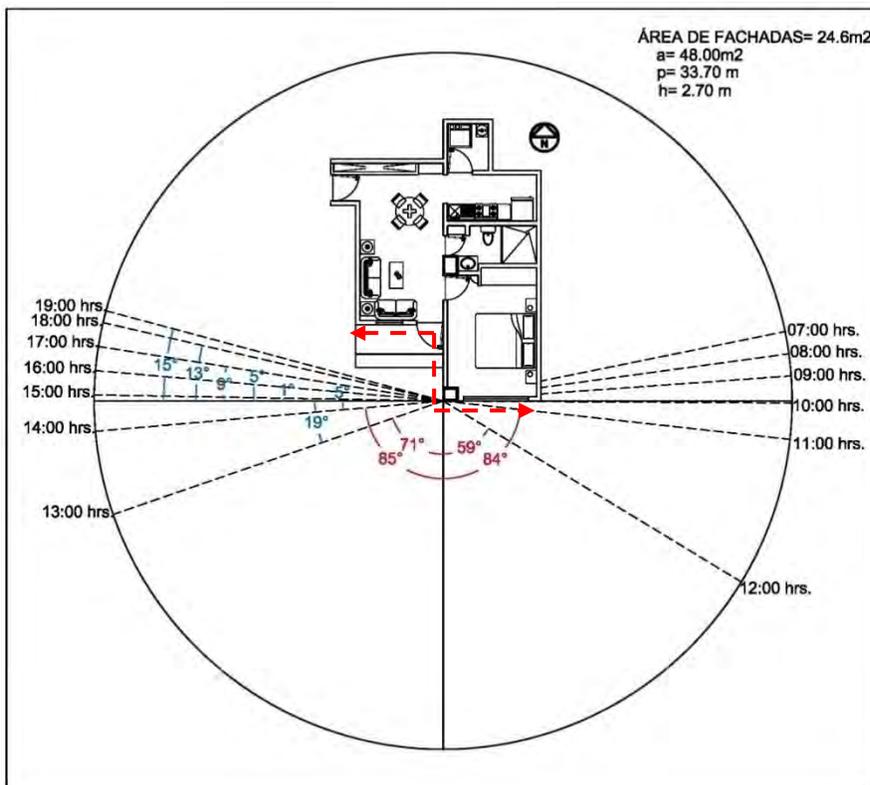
Ángulos de incidencia solar sobre la fachada del departamento tipo planta para el mes de Mayo.
